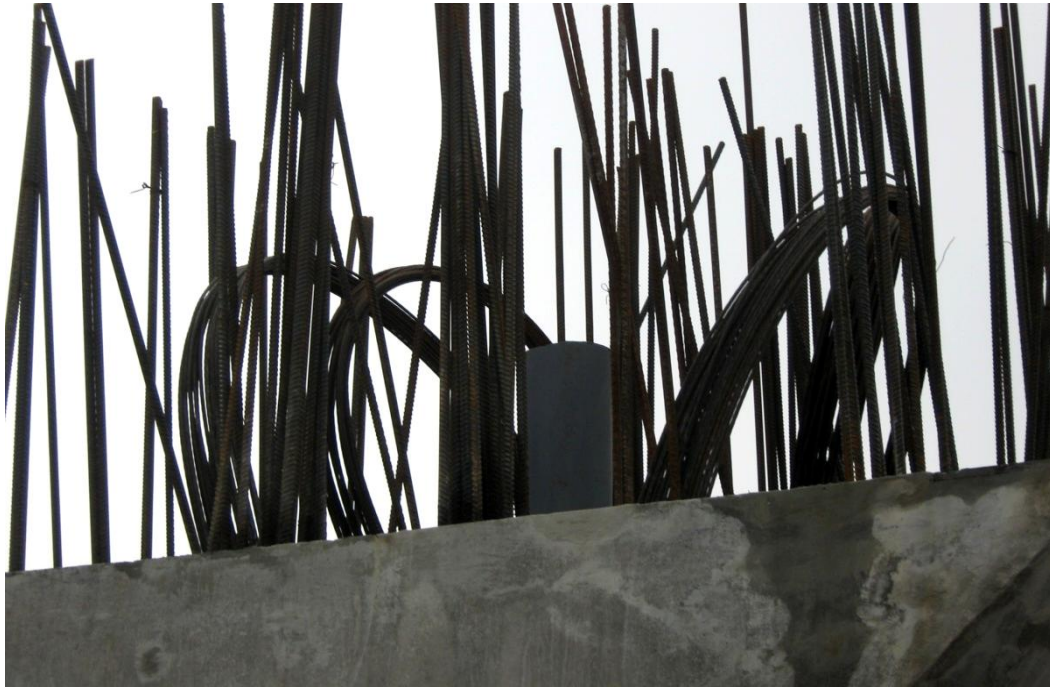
Parte superior de la columna de concreto presforzado, donde se aprecia el acero de presfuerzo y el acero ordinario
